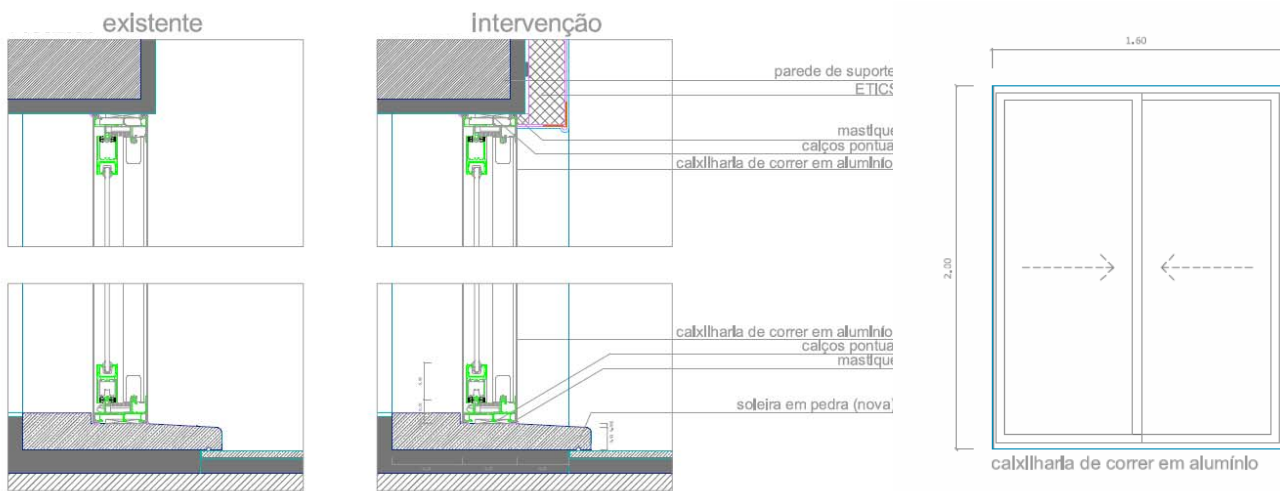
Novo vão de habitação recuada da cobertura. Pormenor construtivo vertical (escala 1/10).
